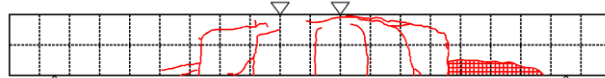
L-0 終局時ひび割れ図（12.5 万回）
